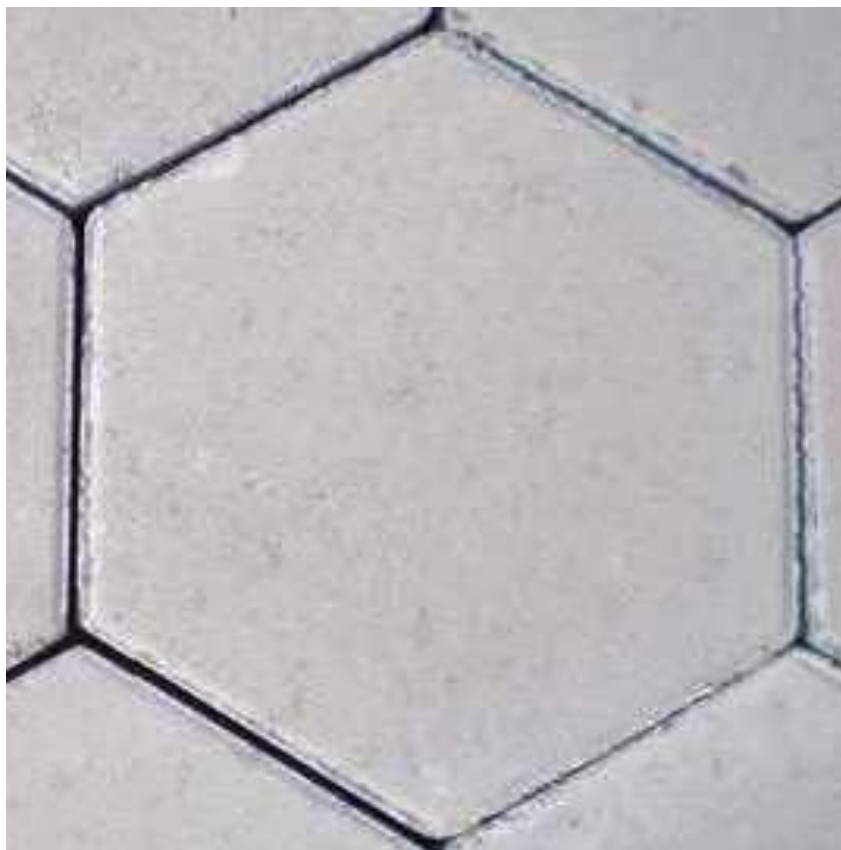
“Bloquete”, ou lajota sextavada em concreto pré-moldado. – Fck 35 Mpa.
